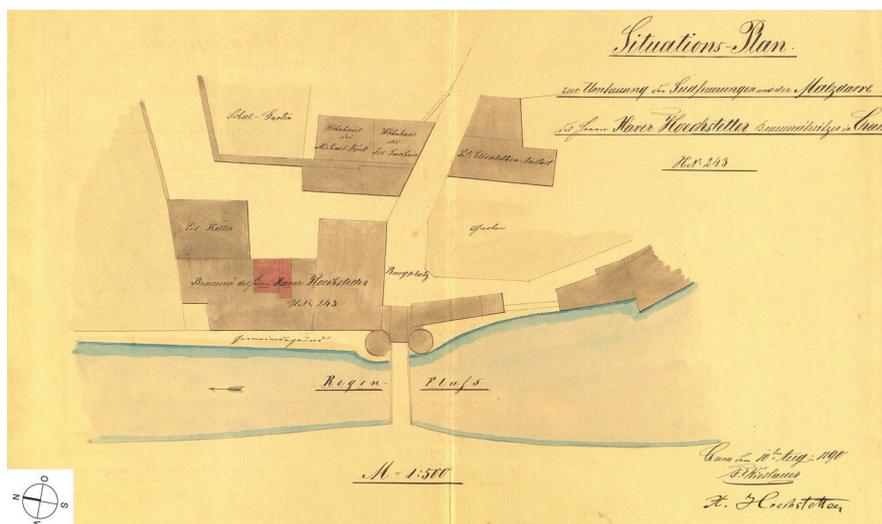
Lageplan der Höchstetterbrauerei zur Errichtung einer Malz-Darre aus dem StAAM/Bezirksamt Landratsamt Cham, Baugenehmigungsakte 150/1890 (Bereich des Umbaus ist rot eingefärbt)
